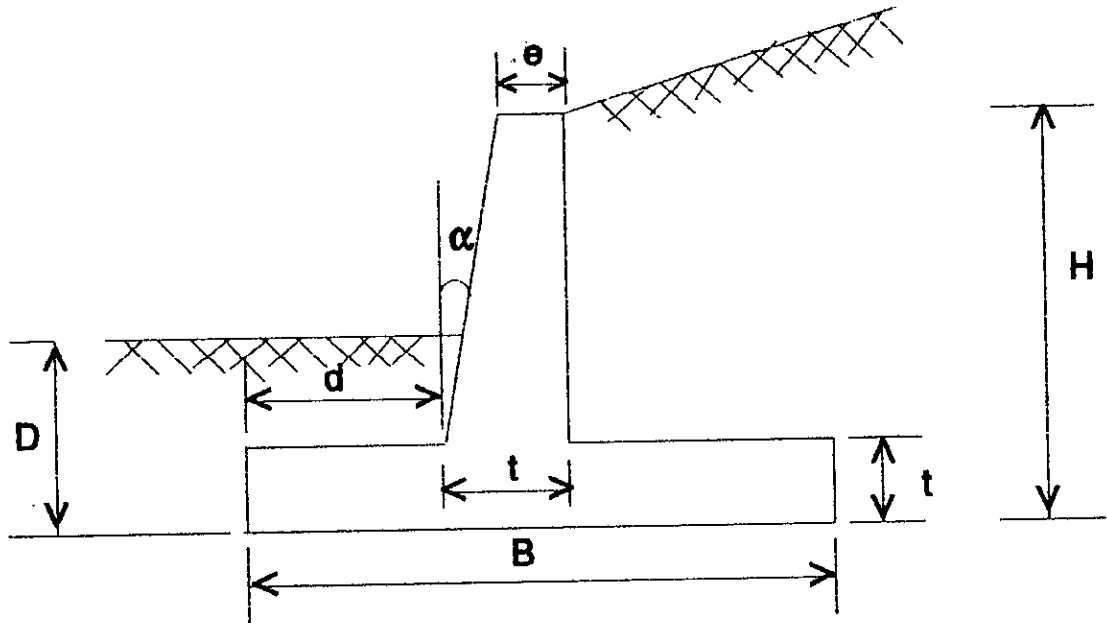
Dimensions usuelles d'un mur profilé en béton armé
